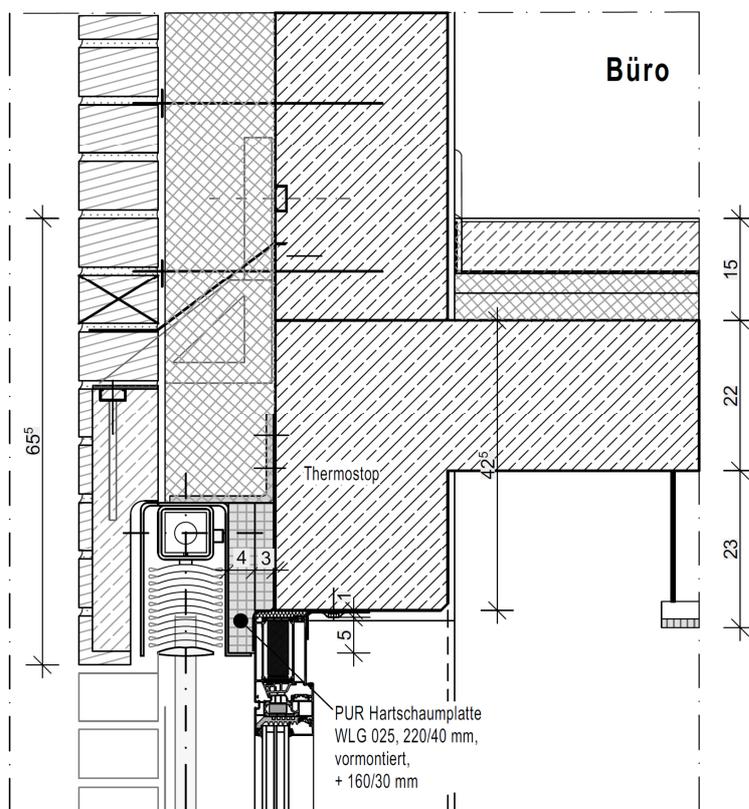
Fassadenschnitt: Fenster mit Raffstore und Kerndämmung
